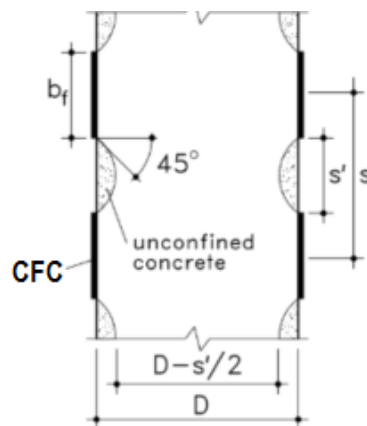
Zonas não confinadas do encamisamento parcial de um pilar (adaptado do FIB Bulletin 14, 2001).
